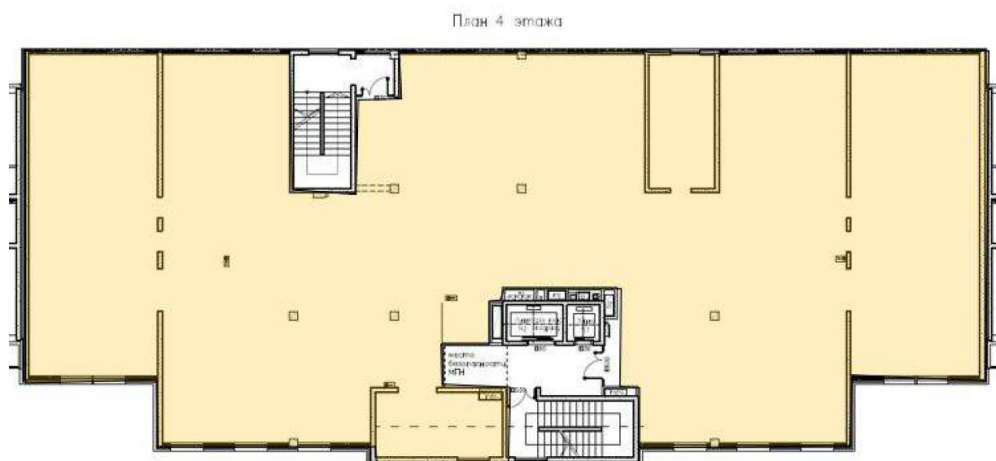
План 4 этажа БС-13 ЖК URAL
